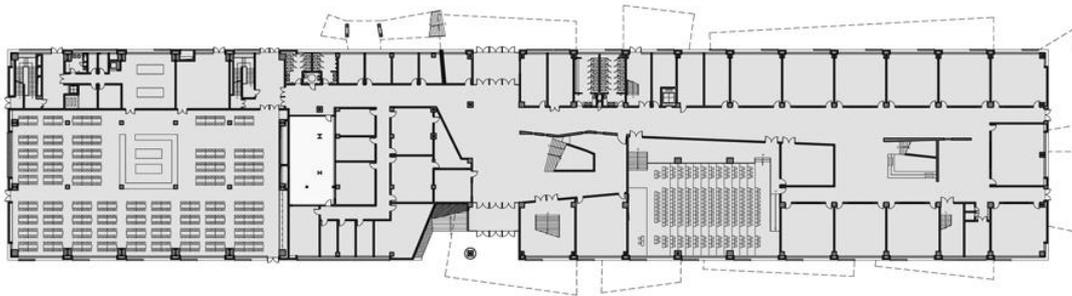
PLANTA PRIMEIRO PAVIMENTO
